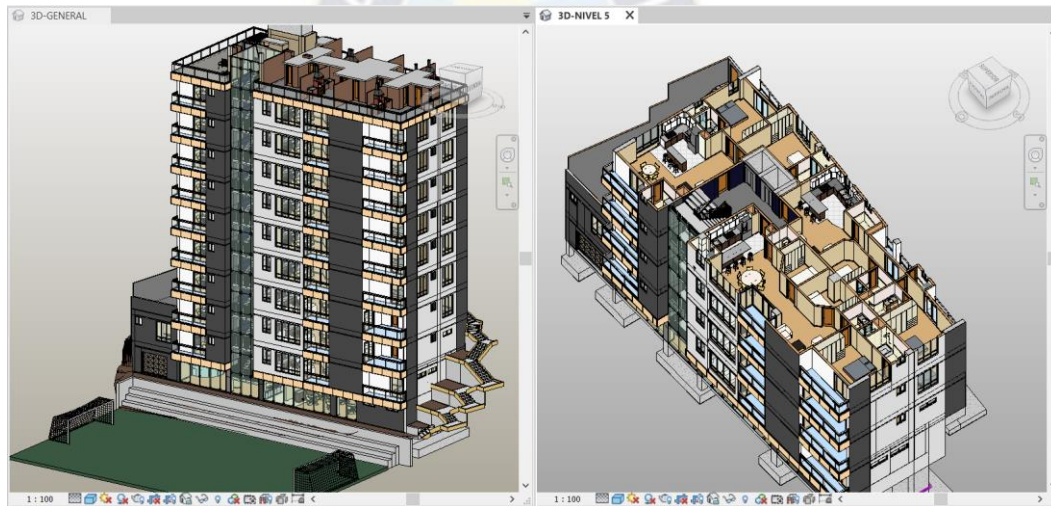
Modelado de Detalle del diseño arquitectónico - Fuente: Elaboración propia.
